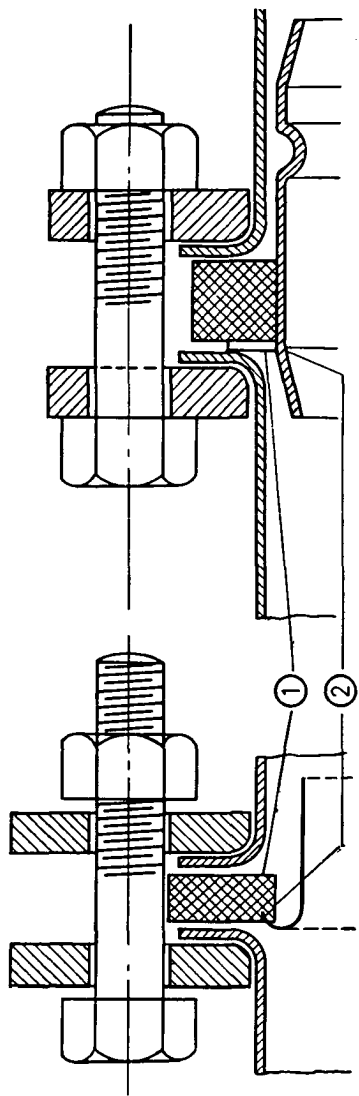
Joints à colliers pour l'assemblage des canars de tôle galvanisée.
